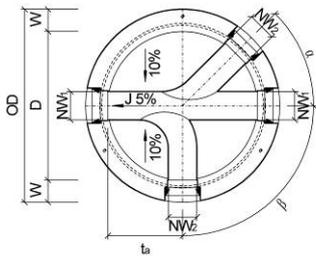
Grundriss CRENO Normschachtboden Typ 3
